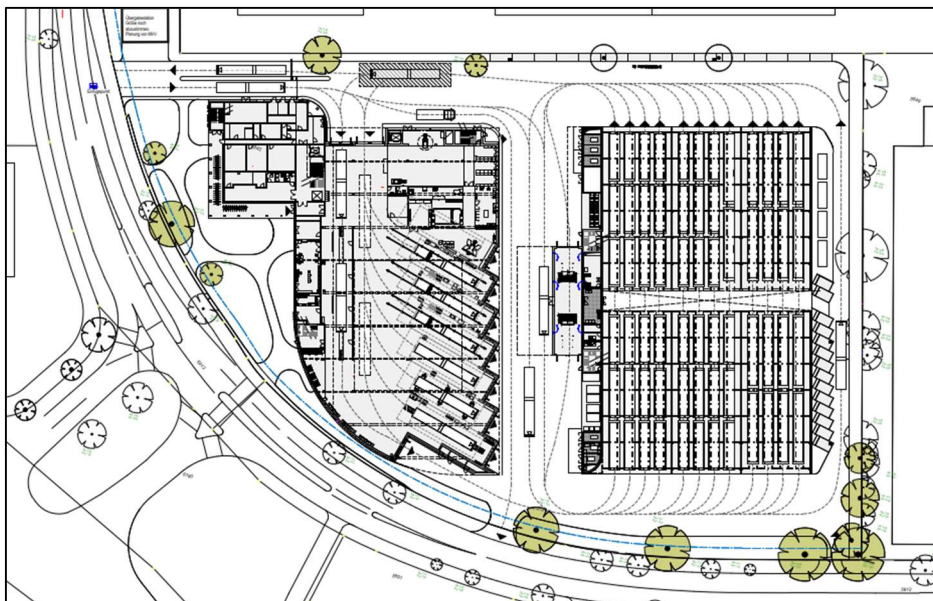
Planskizze, Bildquelle: PLANUNGXGRUPPE
